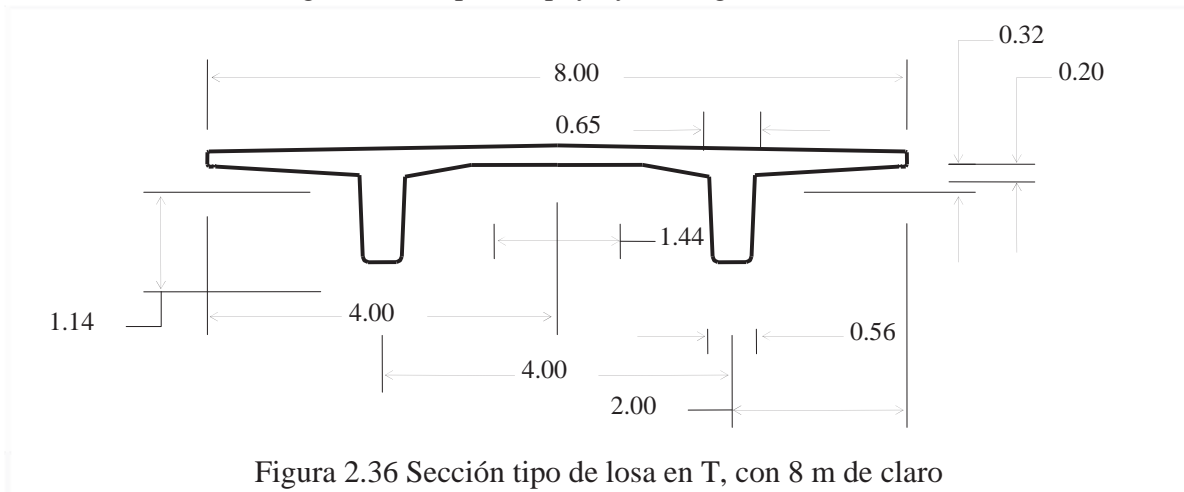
Sección tipo de losa en T, con 8 m de claro
